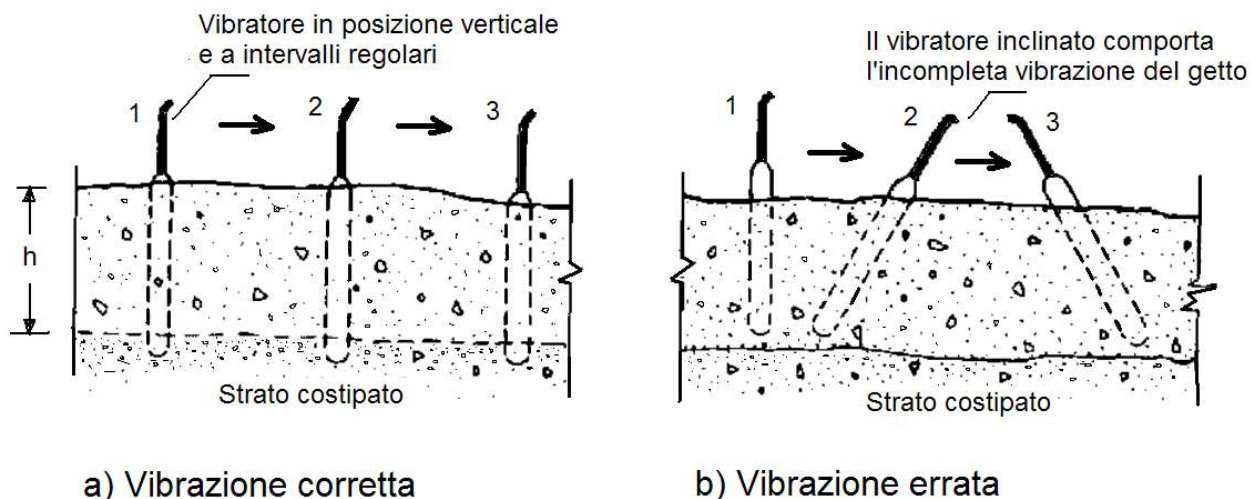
Esecuzione del getto e modalità di costipazione mediante vibrazione interna
